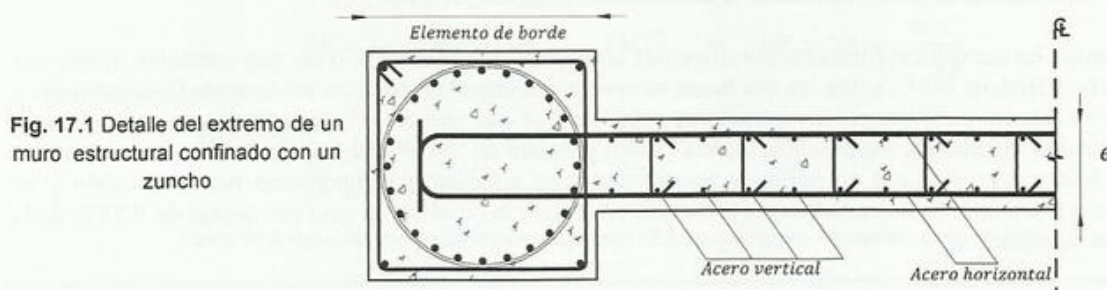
Detalle del extremo de un muro estructural confinado con un zuncho
